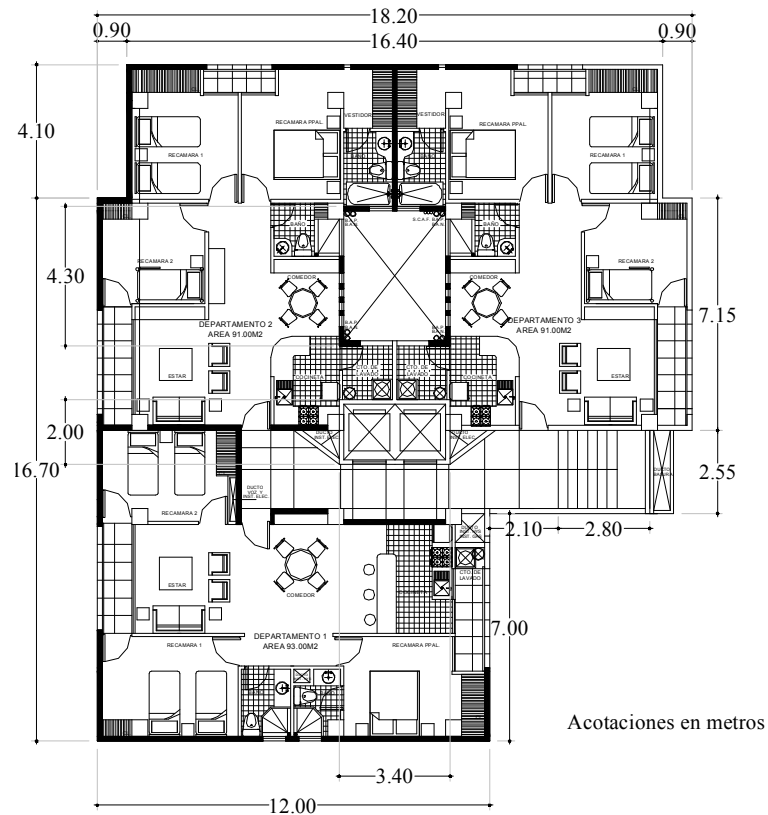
PLANTA DE ENTREPOS 1 AL 8
